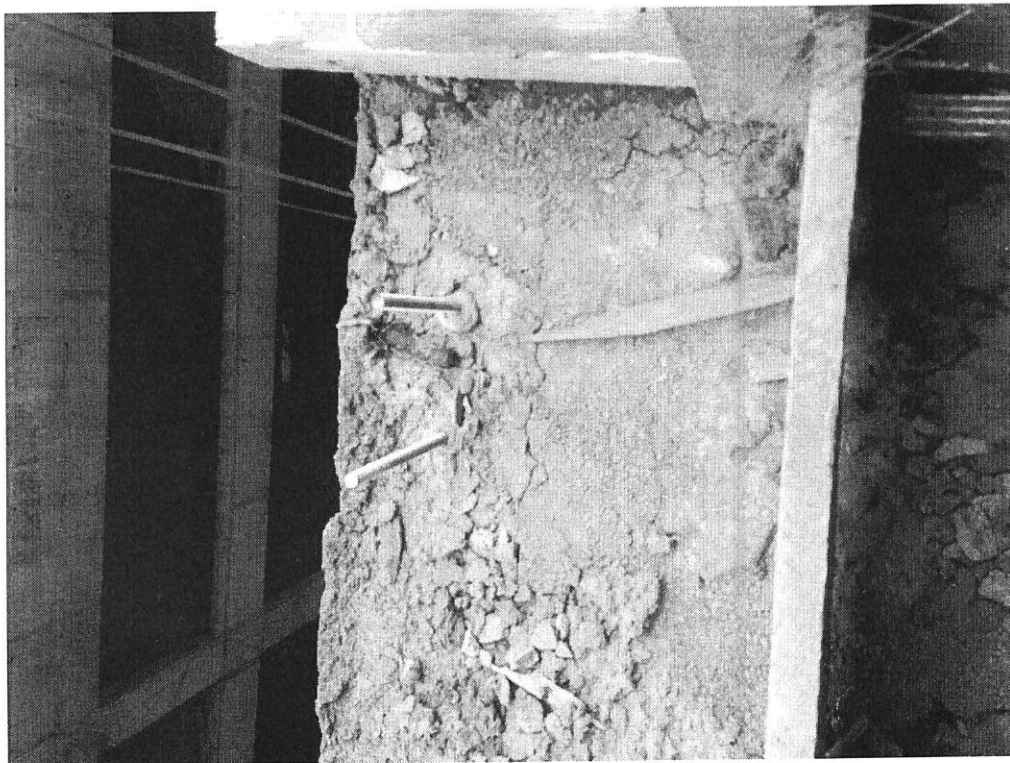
Parafusos devidamente fixados à estrutura de concreto, mas sem o *insert
